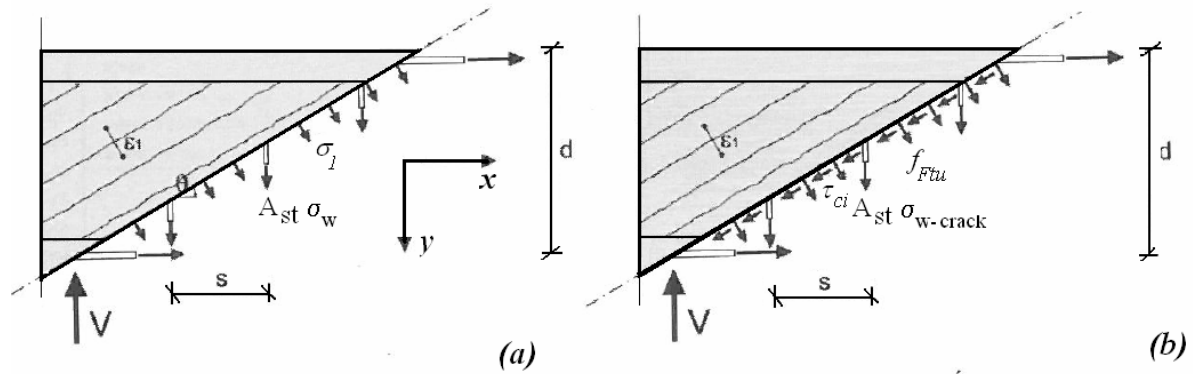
Transmission des efforts à travers les fissures diagonales [poutres en BFM avec étriers] (Minelli et Plizzari, 2010c)
